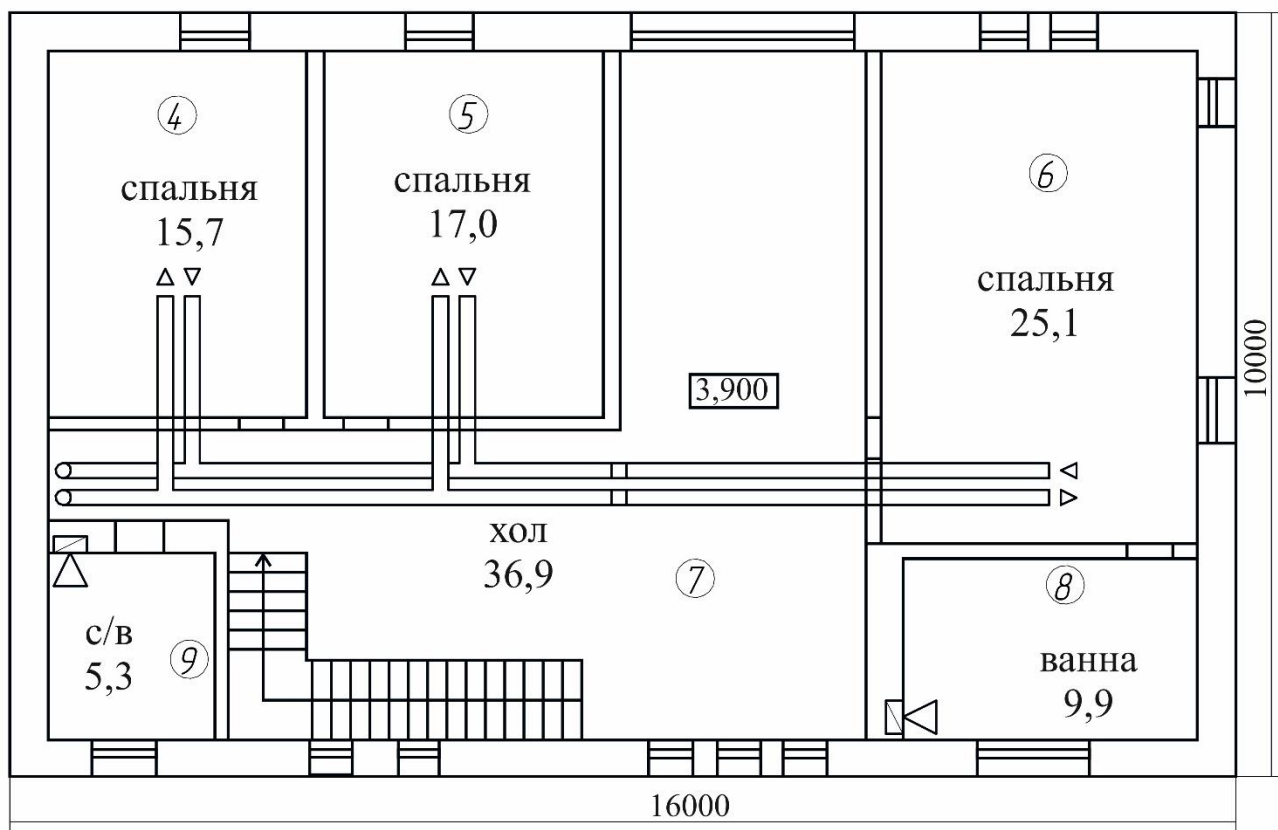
Креслення другого поверху будинку з повітропроводами.
